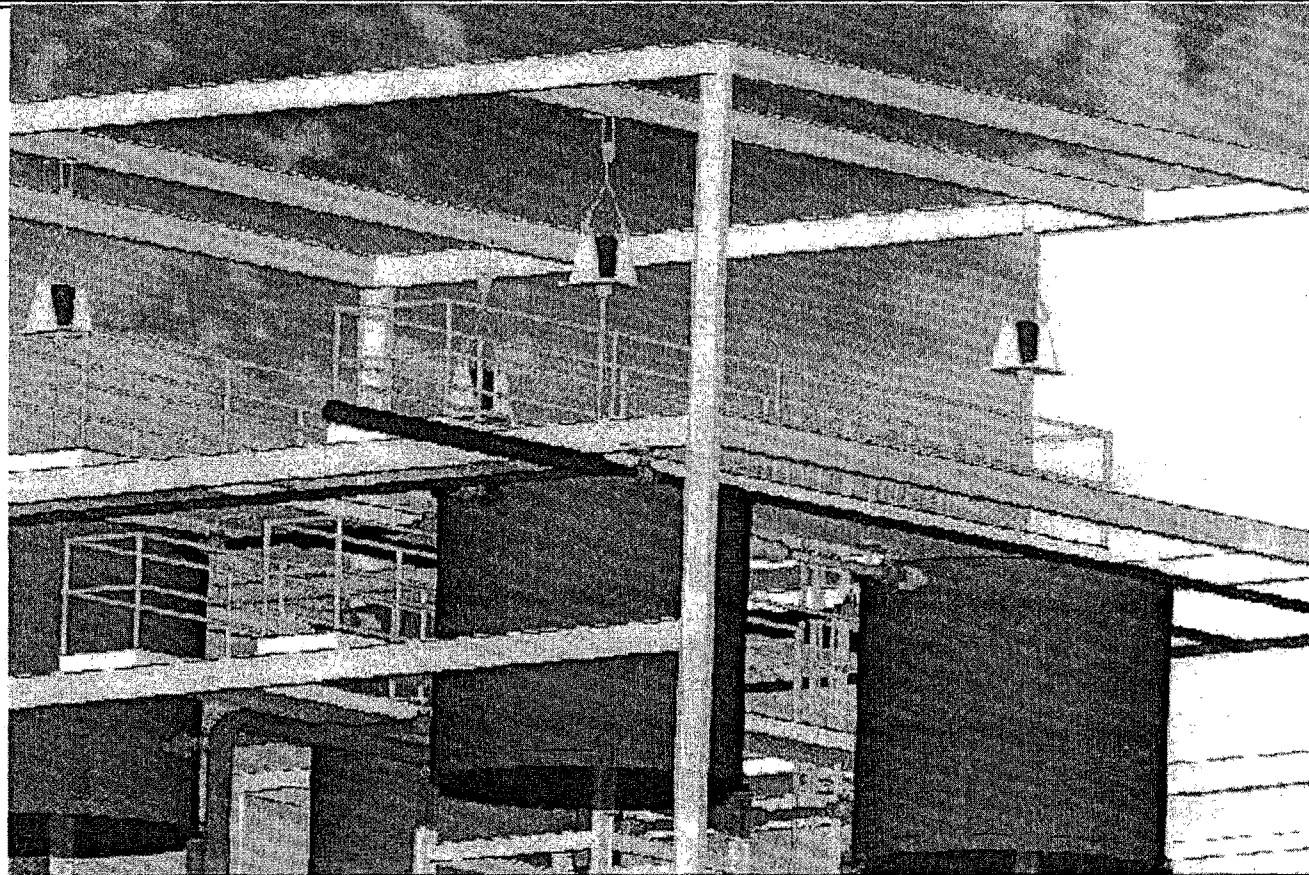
x Vista frontal de la planta de tratamiento propuesta
